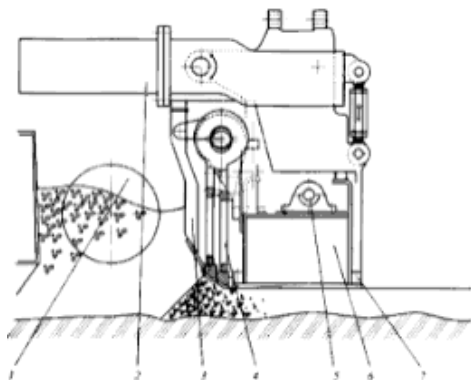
Схема блока рабочих органов асфальтоукладчика: 1 – распределяющий шнек; 2 – боковой несущий рычаг; 3 – выравнивающий щит; 4 – трамбующий брус; 5 – вибратор; 6 – кожух обогревателя выглаживающей плиты; 7 – выглаживающая плита
